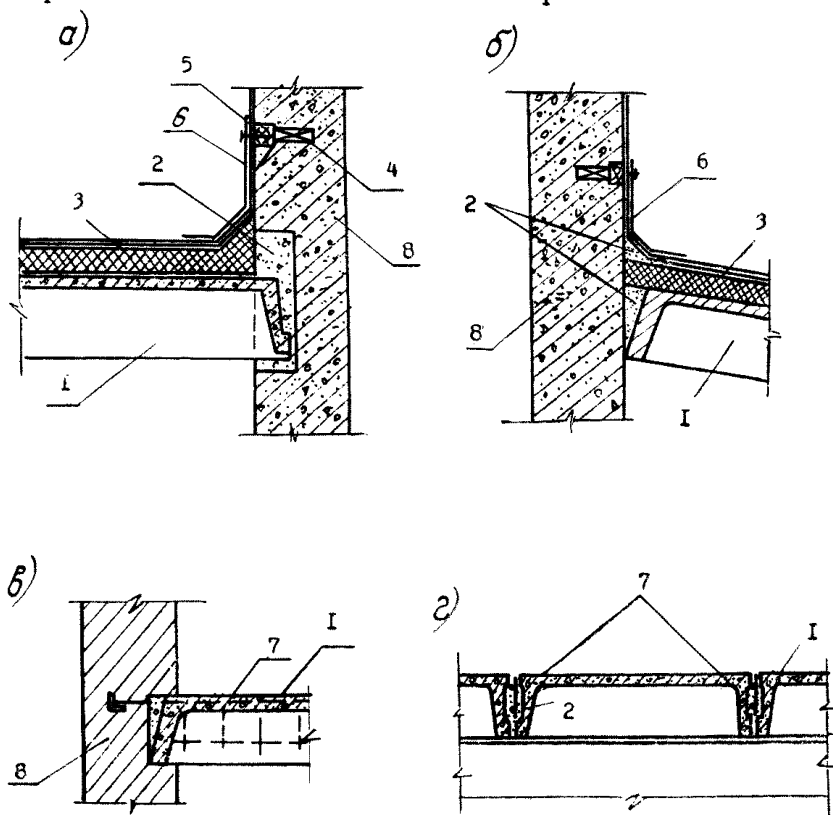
Герметизация конструкций покрытий из сборного железобетона:
